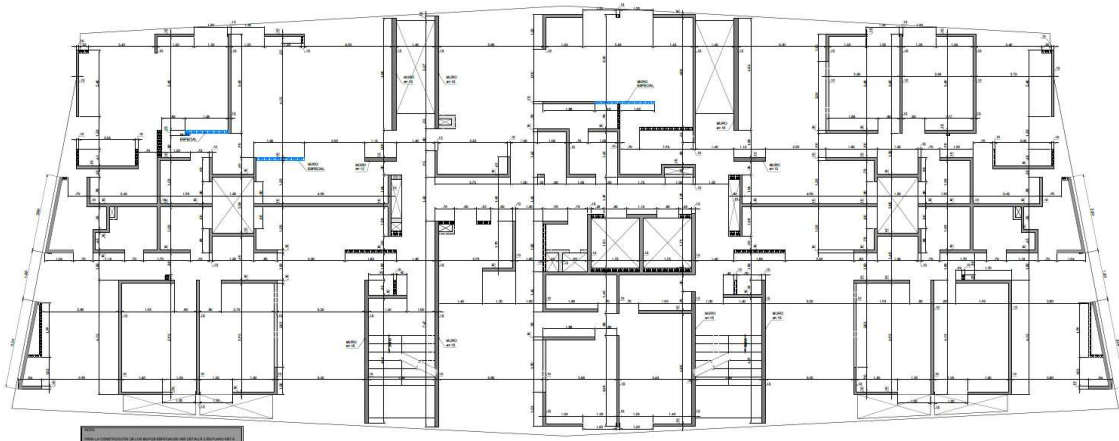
Planta Estructural Piso 18, muros $e=.10$ m. Fuente: Elaboración propia.
